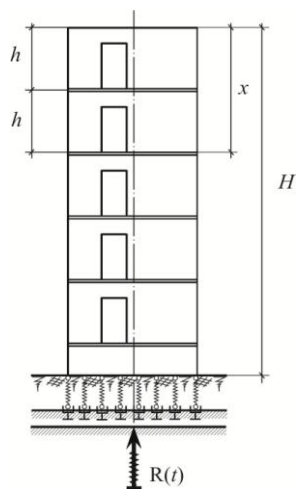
Расчетная схема определения напряжений в стыковых соединениях несущих стен крупнопанельного здания
